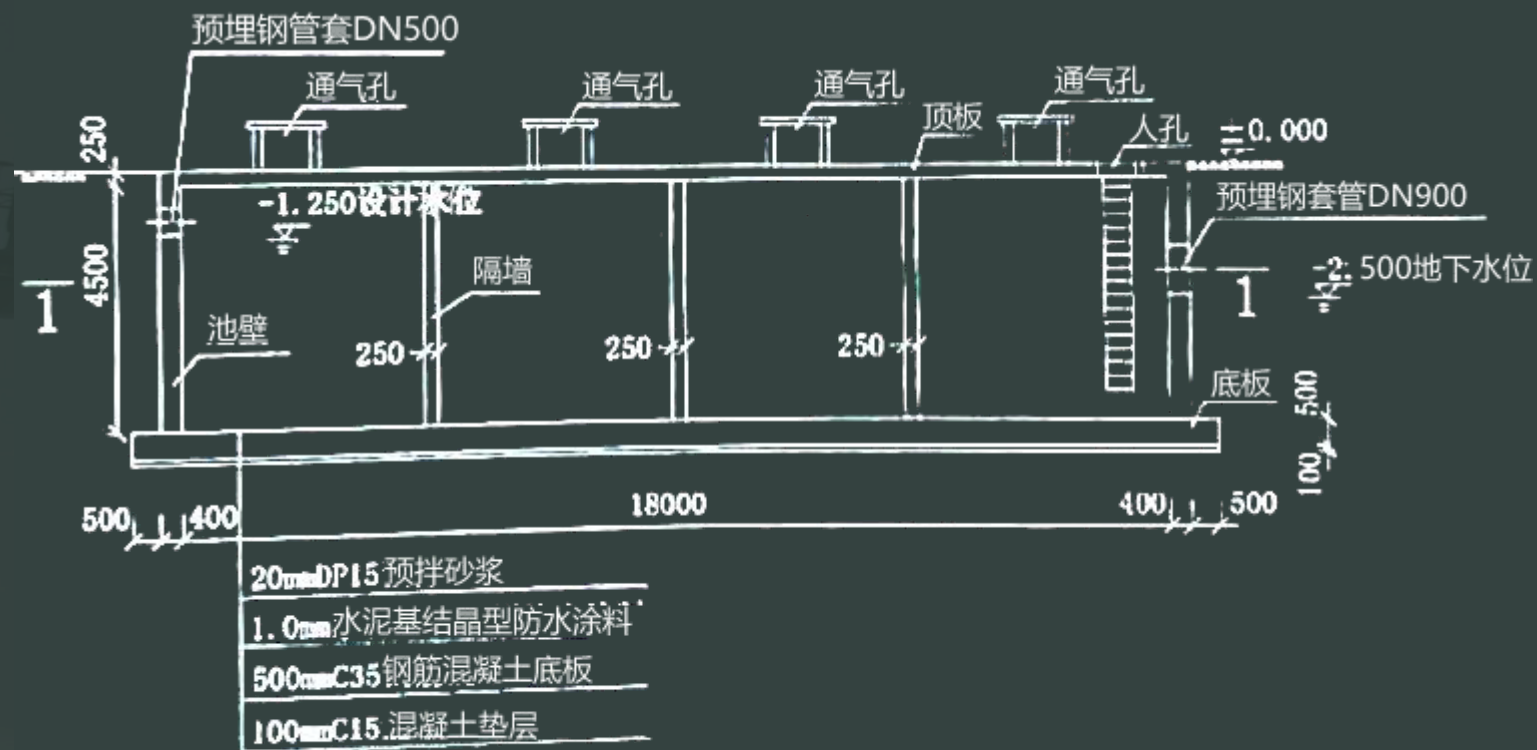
水池剖面图 (标高单位 : m; 尺寸单位 : mm)
